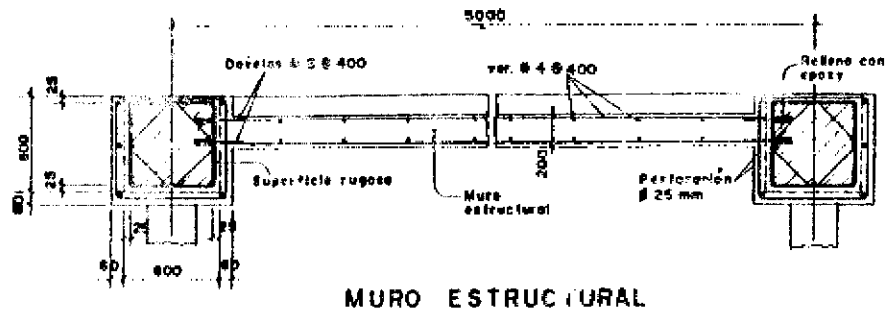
Detalle de ampliación y refuerzo de columnas existentes e integración al muro estructural.
